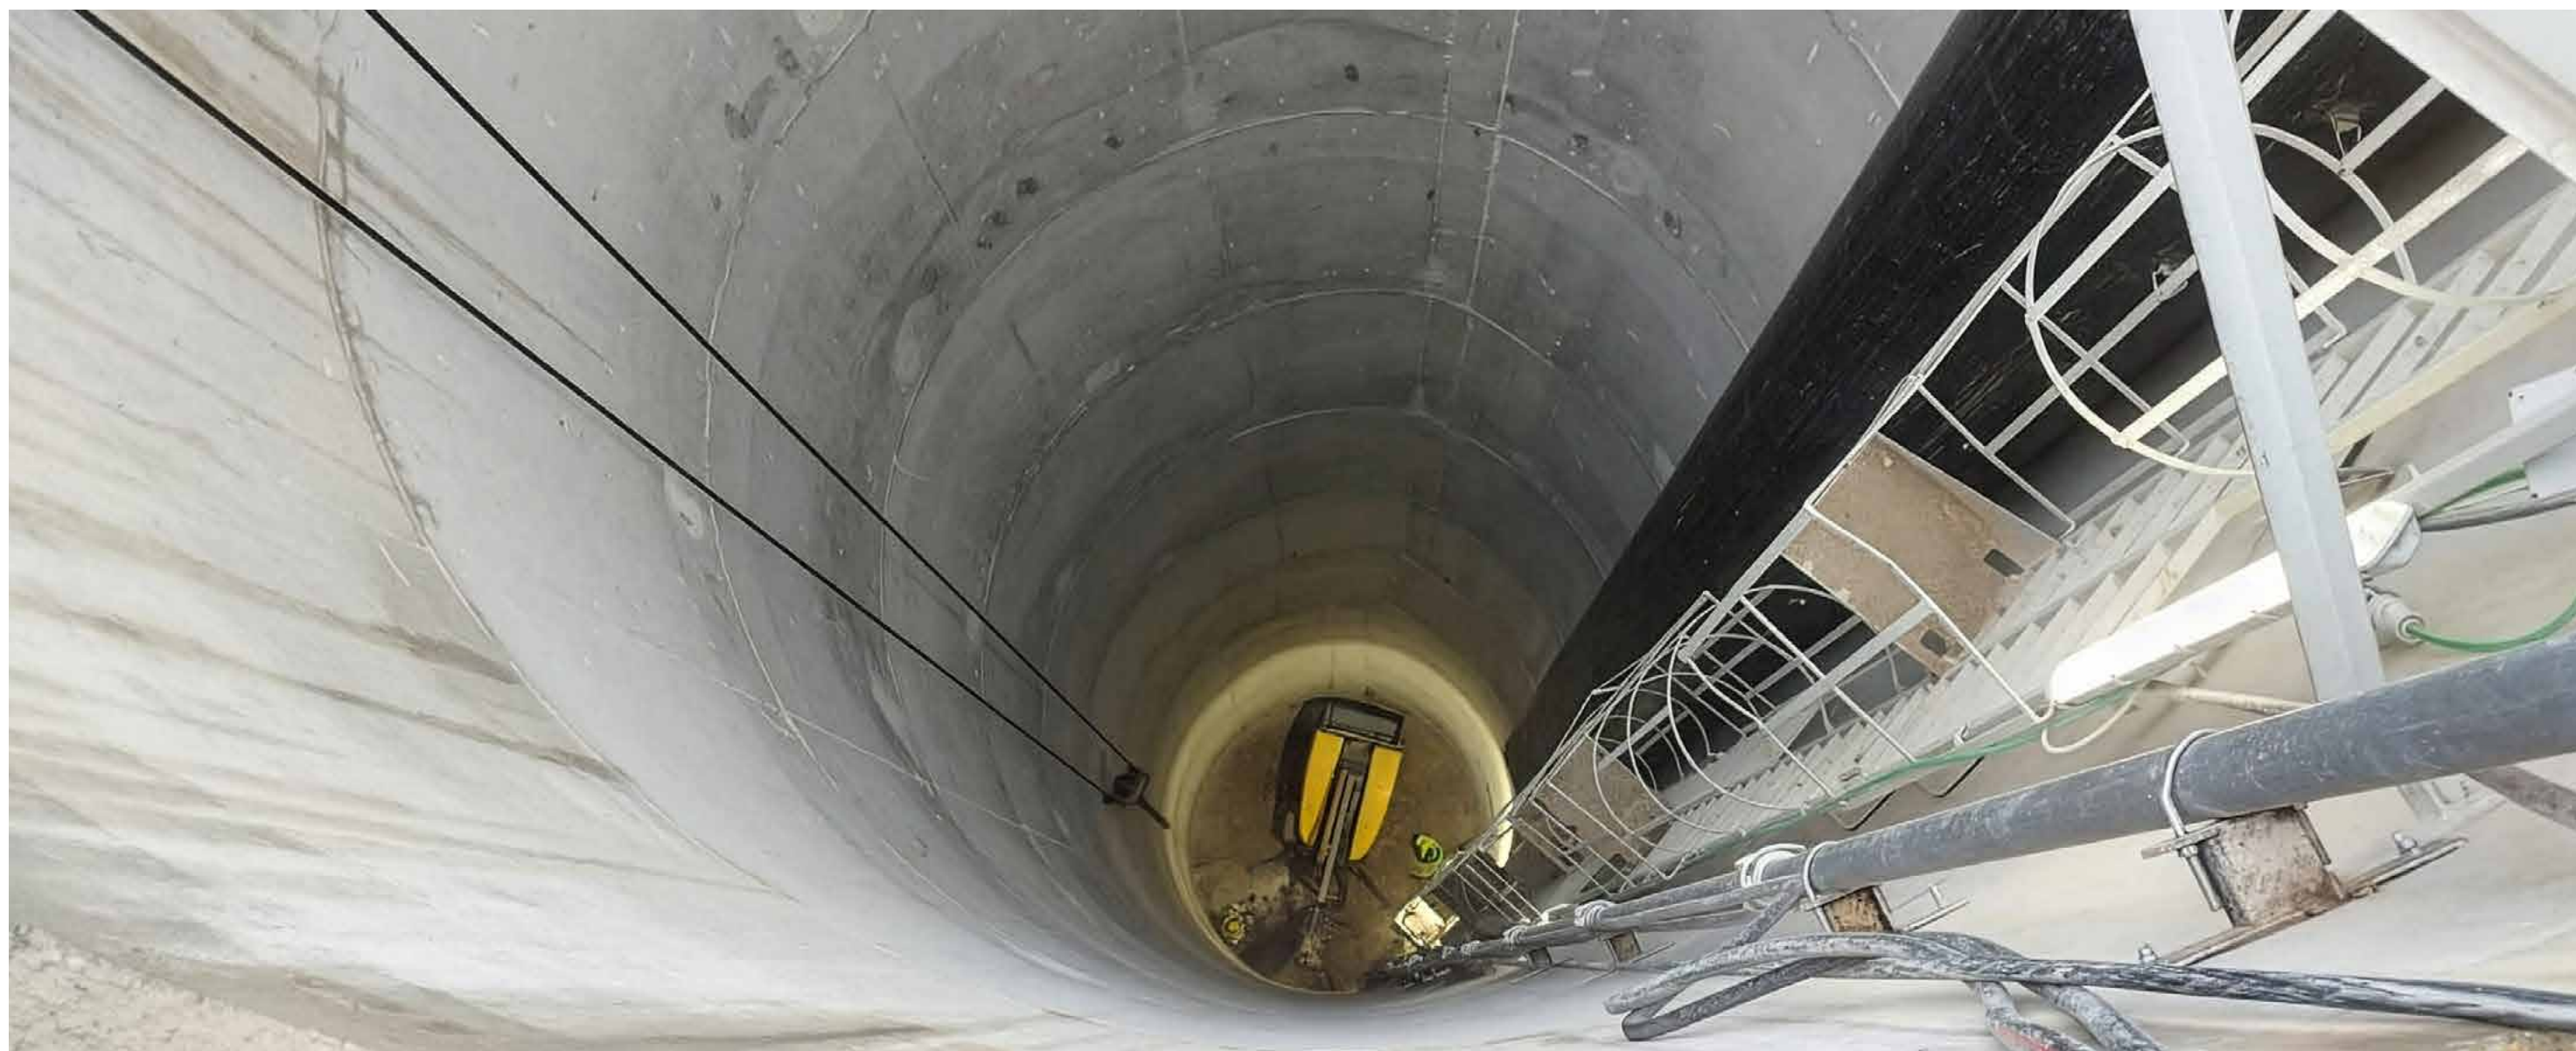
IL POZZO PIEZOMETRICO (SCAVO AUTOPORTANTE)
